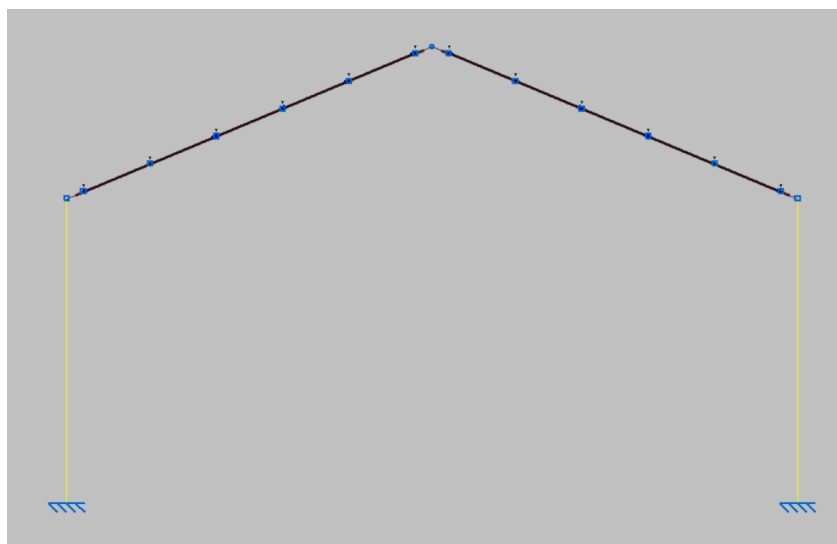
Imagem da estrutura 3D do armazém (Fonte: Autor)
